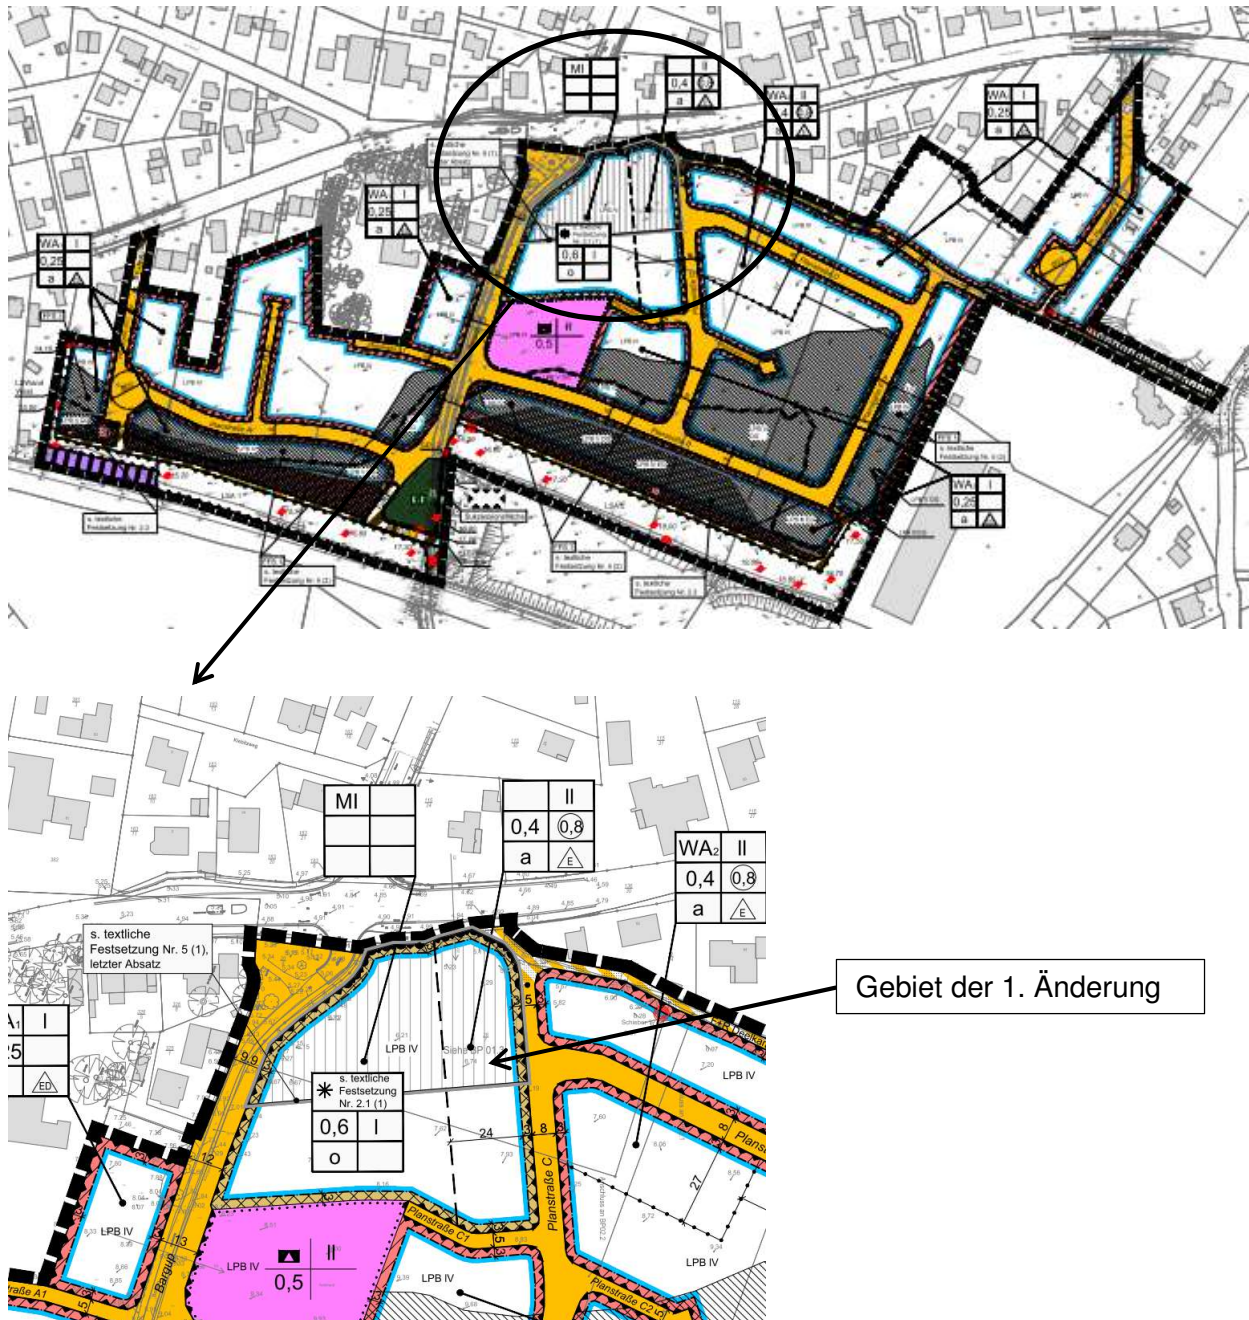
Bebauungsplan Nr. 242 und Ausschnitt des Geltungsbereiches der 1. Änderung
